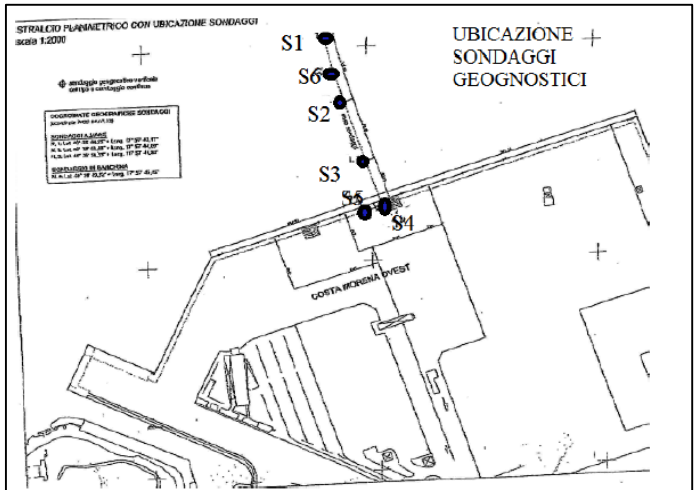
Planimetria con l'ubicazione delle indagini.
